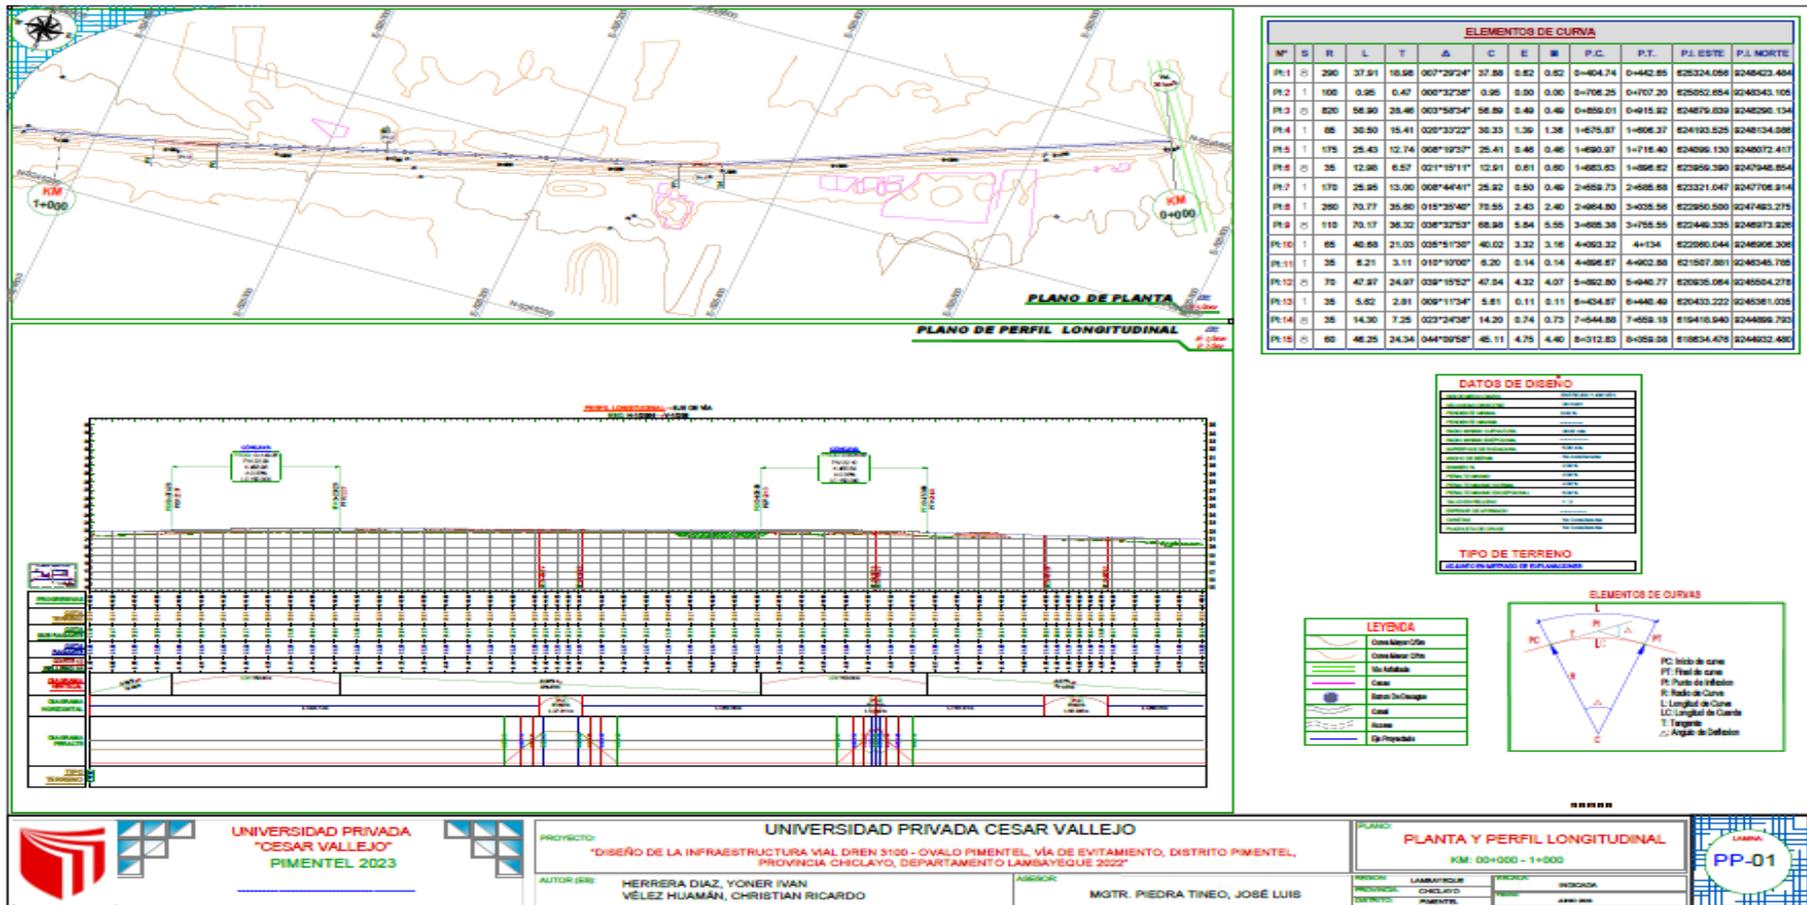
Planta y perfil longitudinal KM: 0+000 - 1+000
